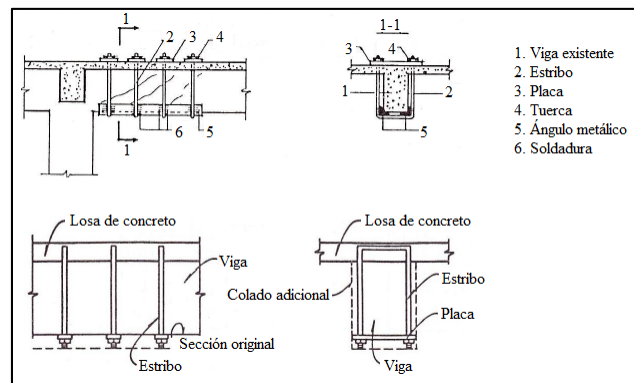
Refuerzo de vigas con estribos pos tensados. (Armendáriz, 2015)
